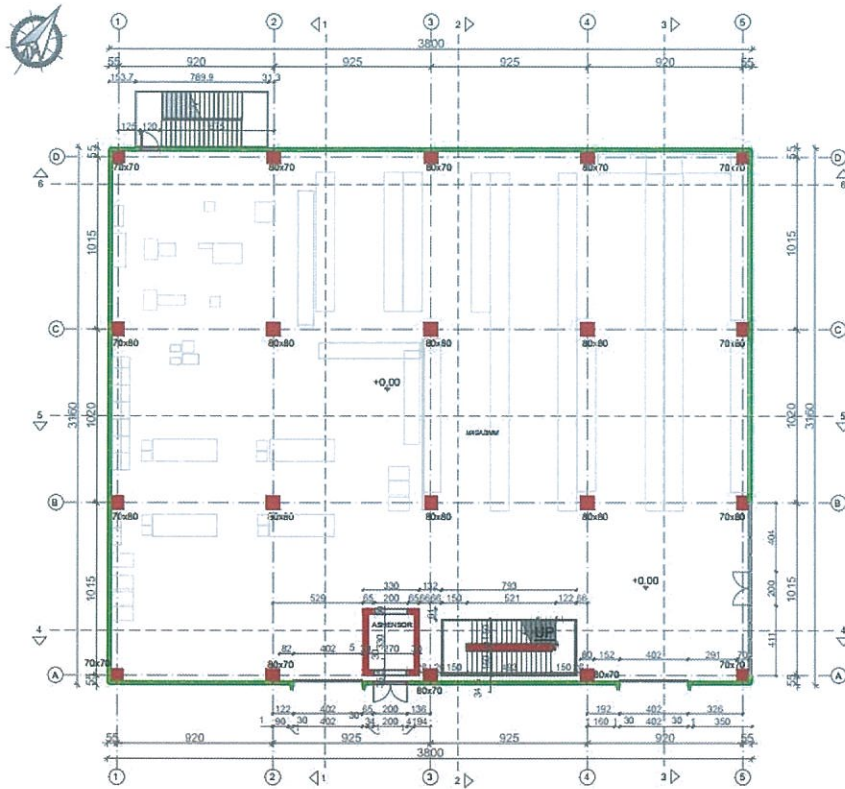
Planimetria e katit përdhe, kuota ± 0.00
